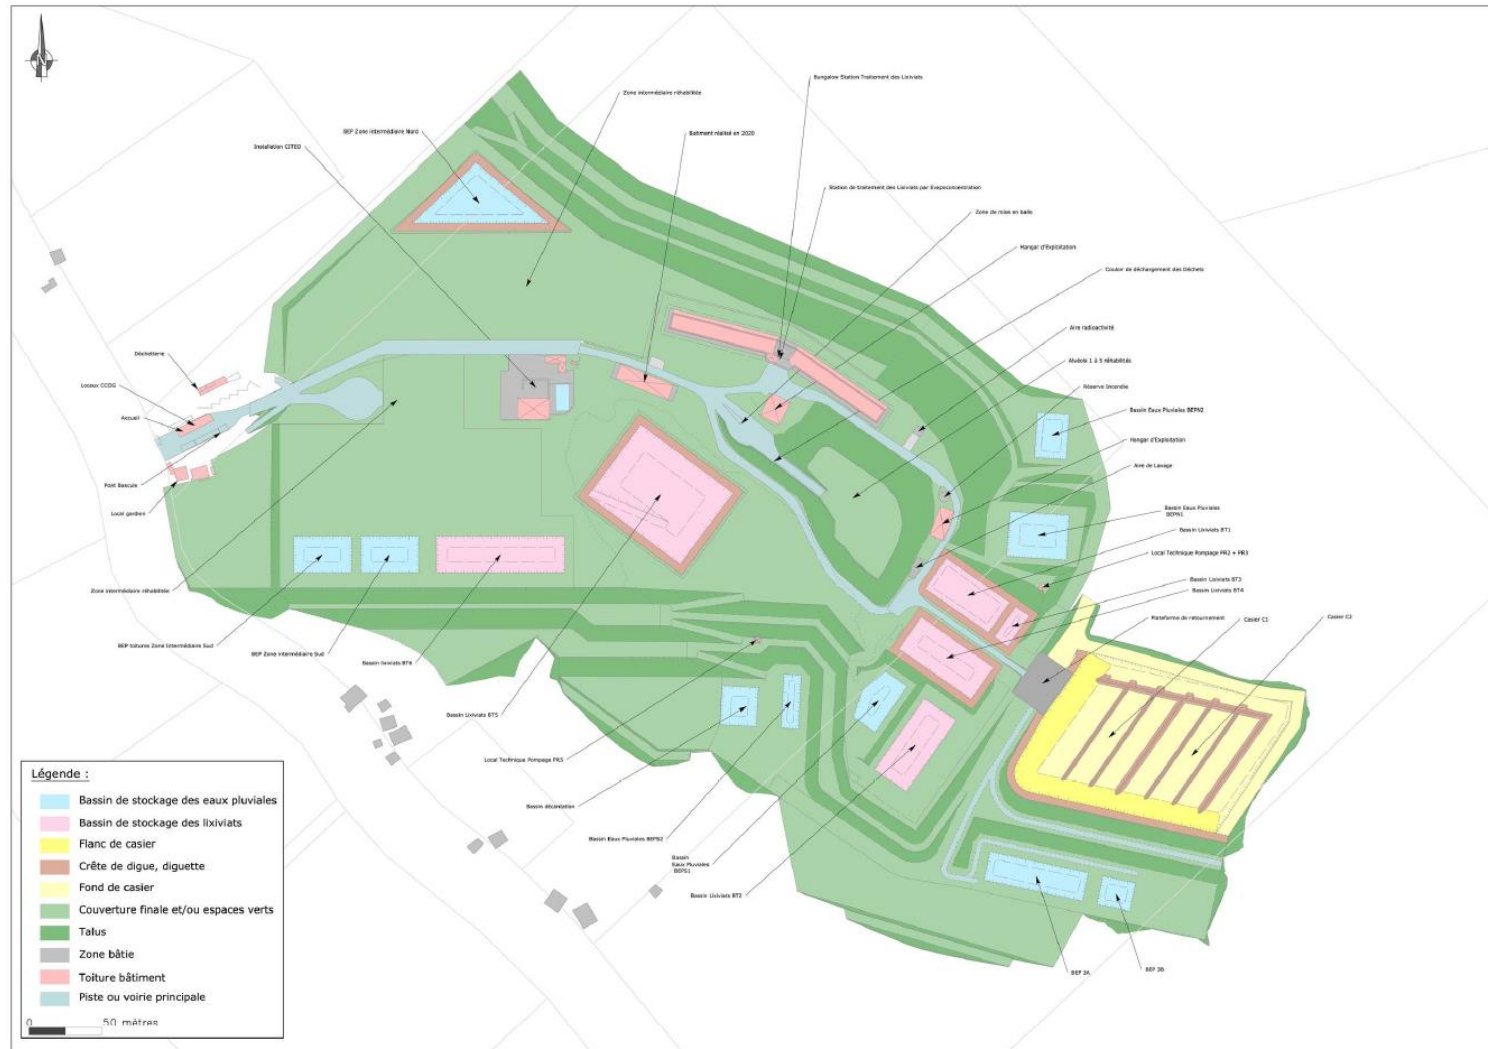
Plan général des installations existantes (Source : BETA Environnement)
